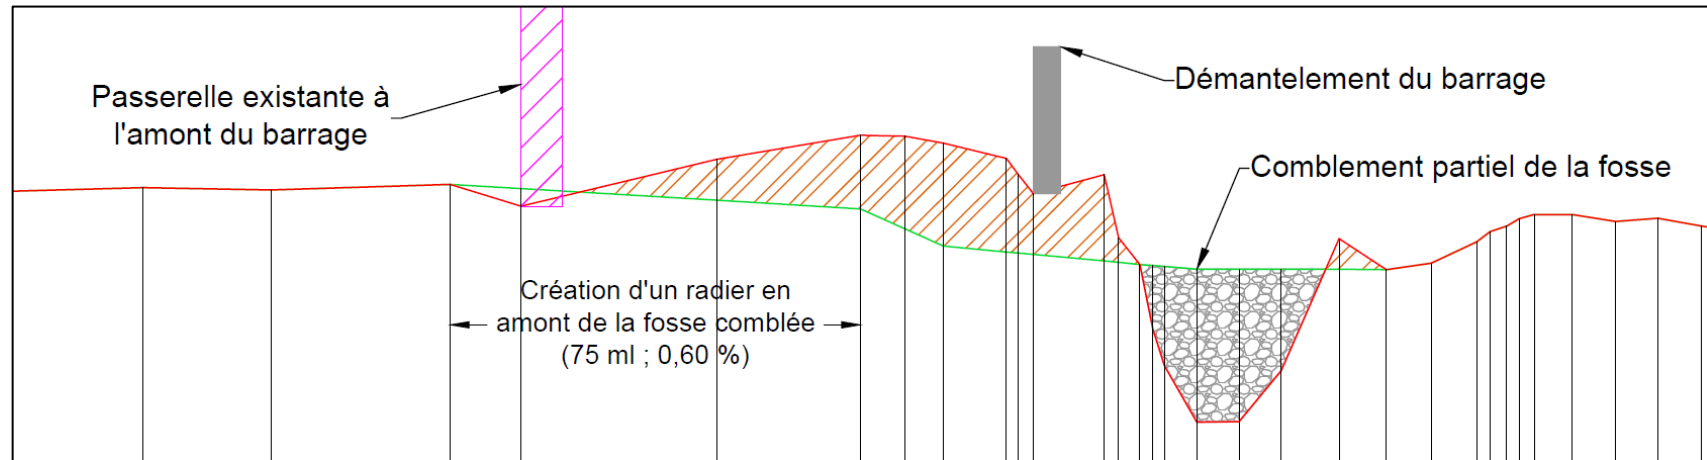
Profil en long de l'Allan au droit du barrage (scénario RCE1)
